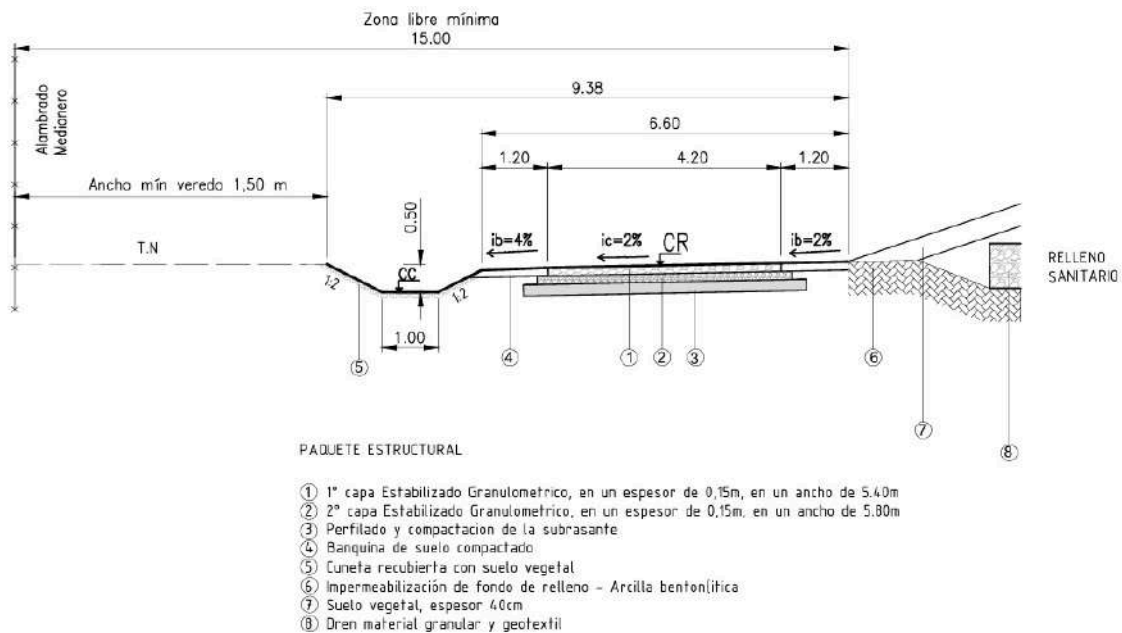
Perfil de obra básica y pavimento de caminos secundarios. Medidas en metros. (Fuente: Elaboración propia)
